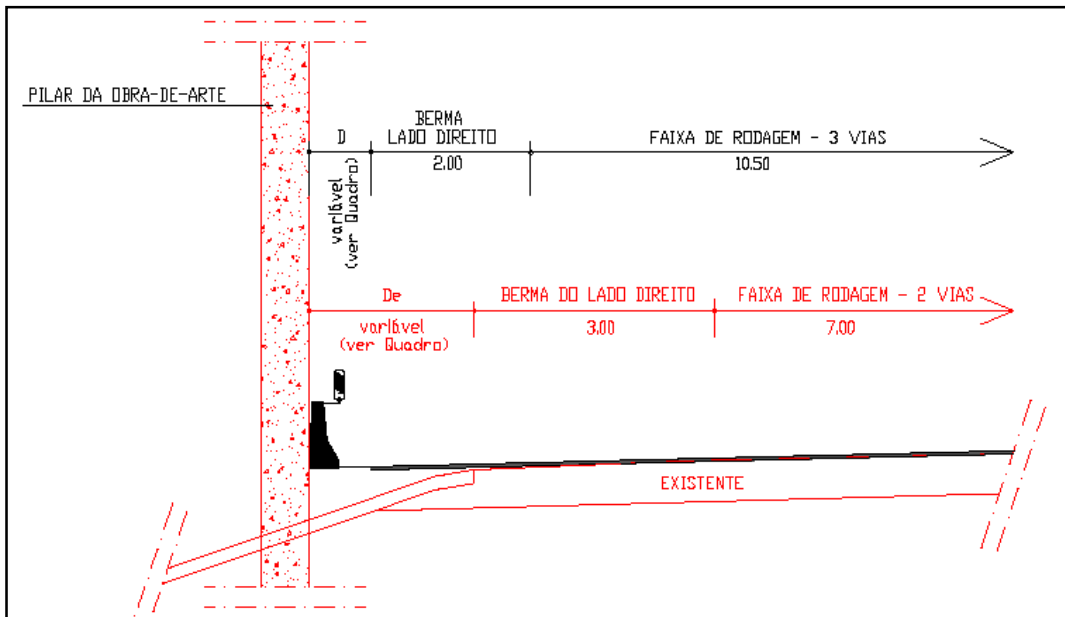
Proteção dos pilares das Passagens Superiores existentes a manter [19]
